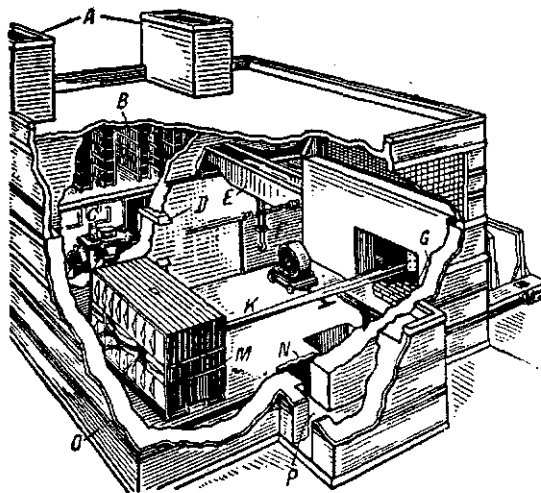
Здание для бетатрона на 100 Мэв.
